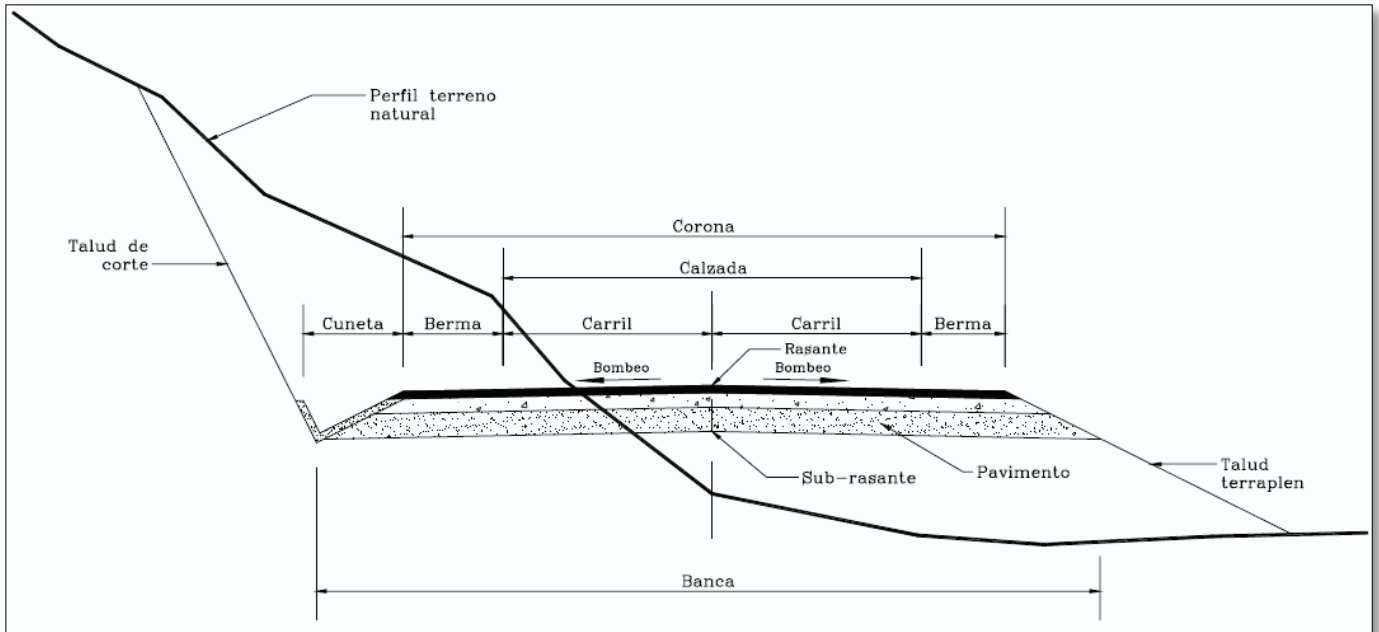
Sección Transversal tipo a media Ladera para una autopista en tangente (13 pág. 184)
